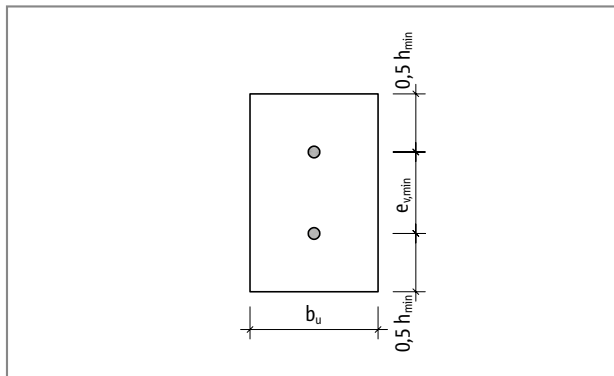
Schöck Dorn type LD : Dimensions minimales de l'élément de construction et distances entre les goujons sur la face d'une poutre ou d'un mur
